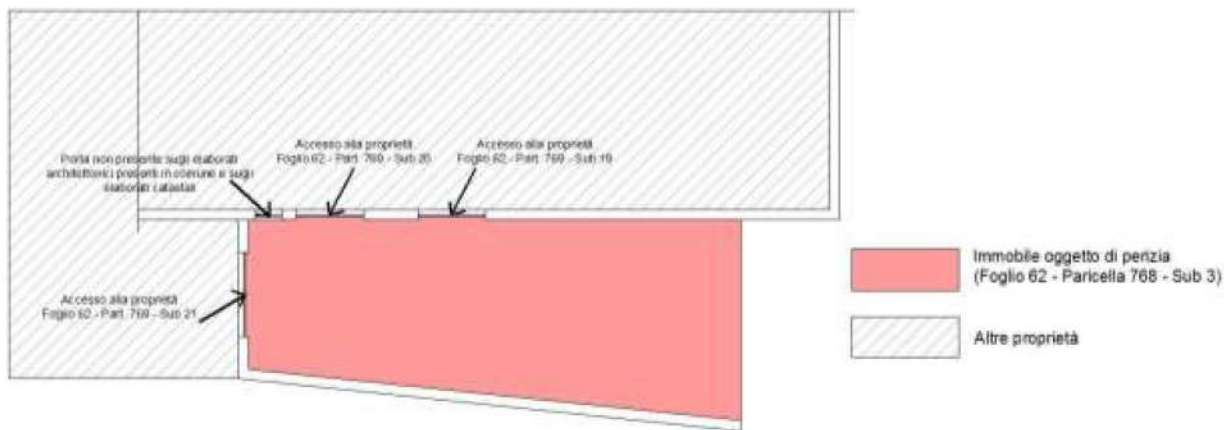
Planimetria rilevata dell'immobile oggetto di perizia (ALLEGATO 6)
